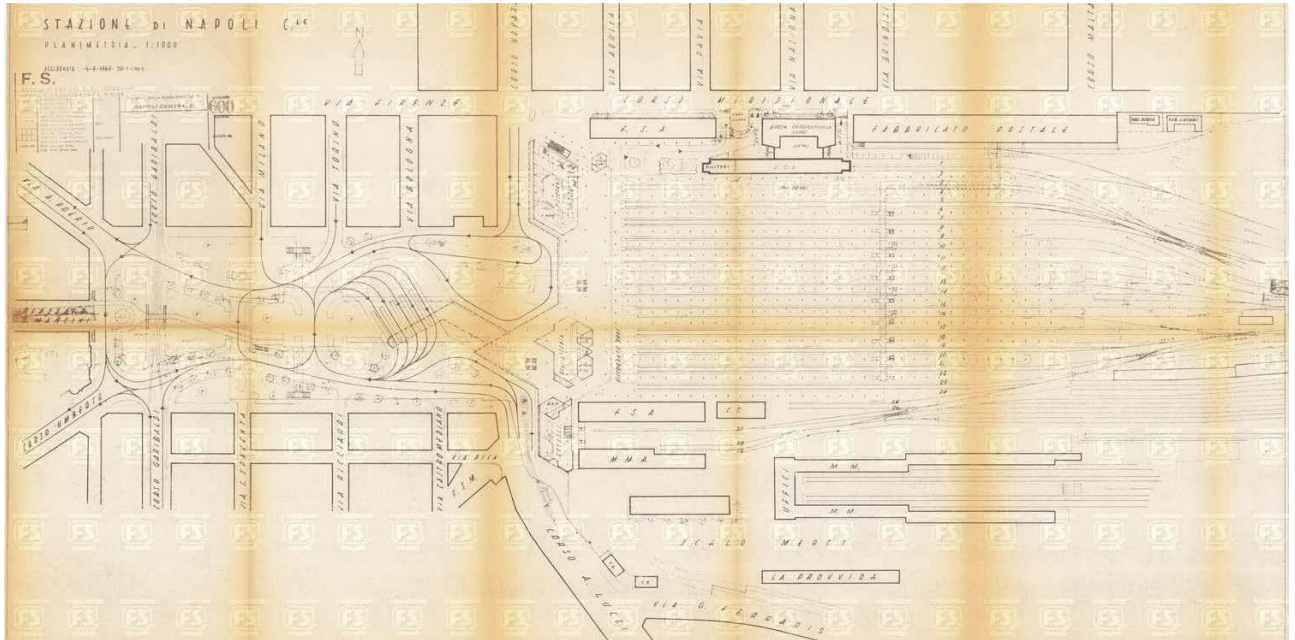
Planimetria di Napoli Centrale e Scalo Merci (1955)
